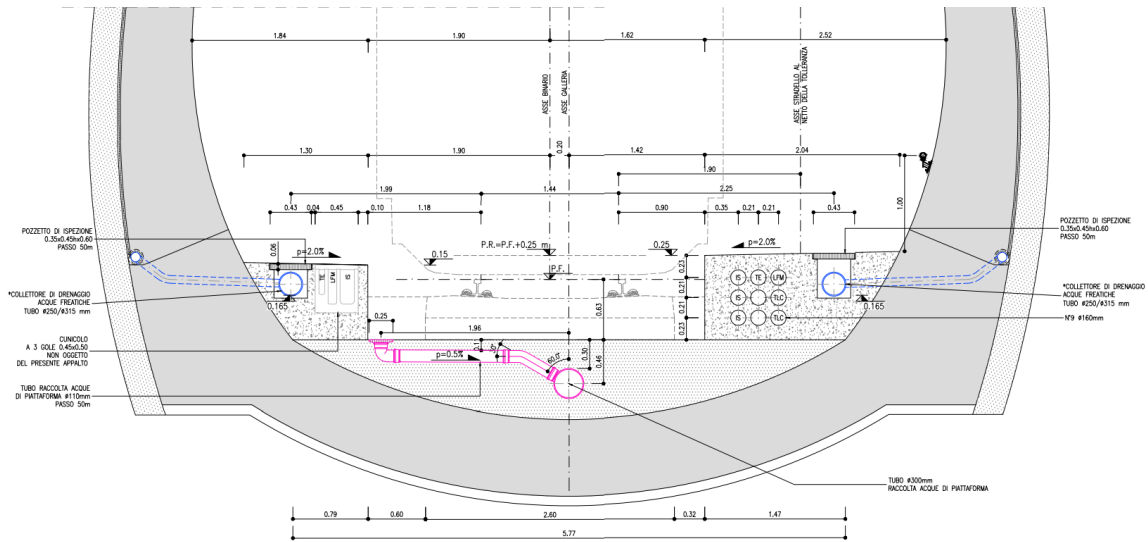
Sezione pozzetti acque di drenaggio - Scavo tradizionale
